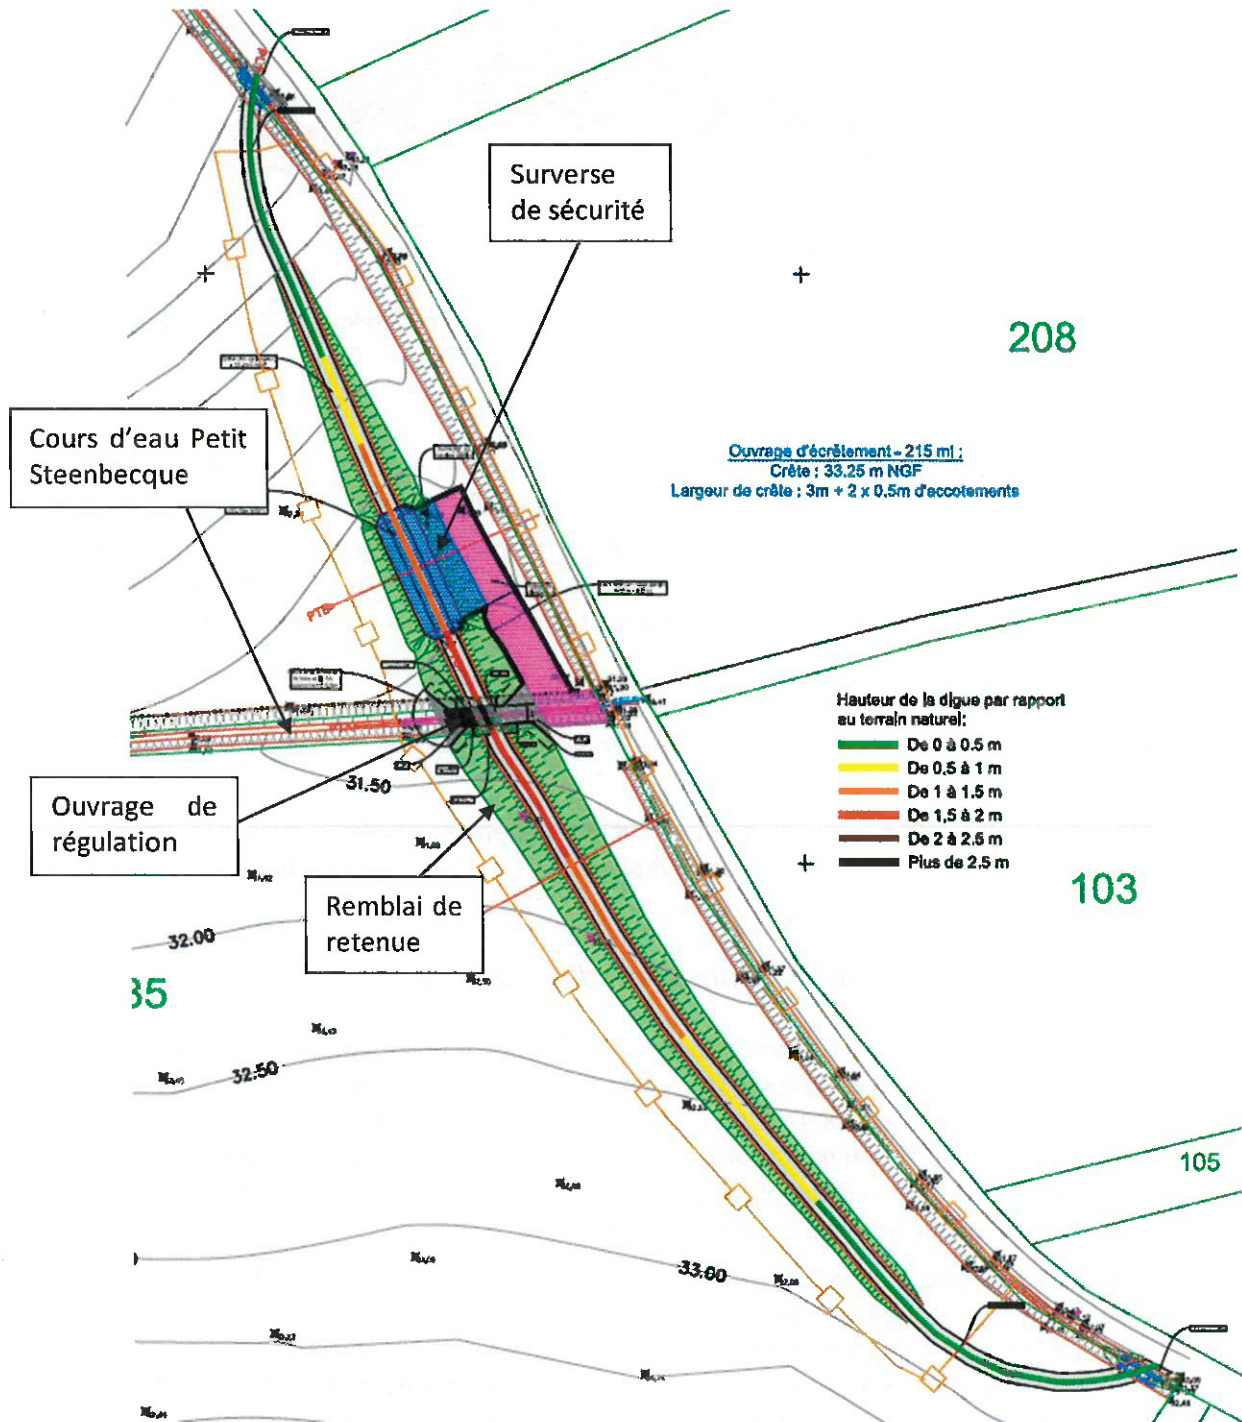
Vue en plan de l'ouvrage de retenue et des ouvrages associés - Steenbecque
